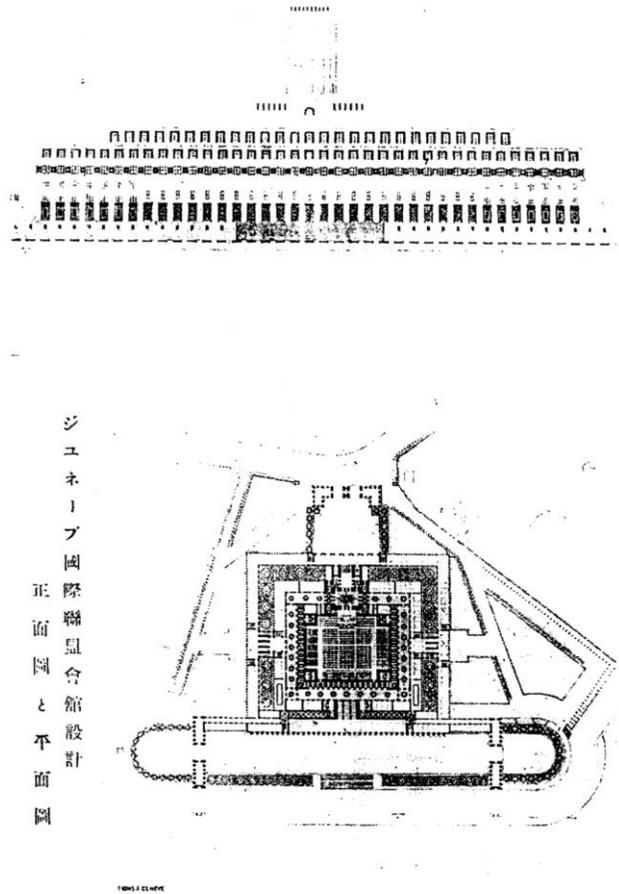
ジュネーブ国際連盟会館設計 吉川清作案 立面図・平面図
